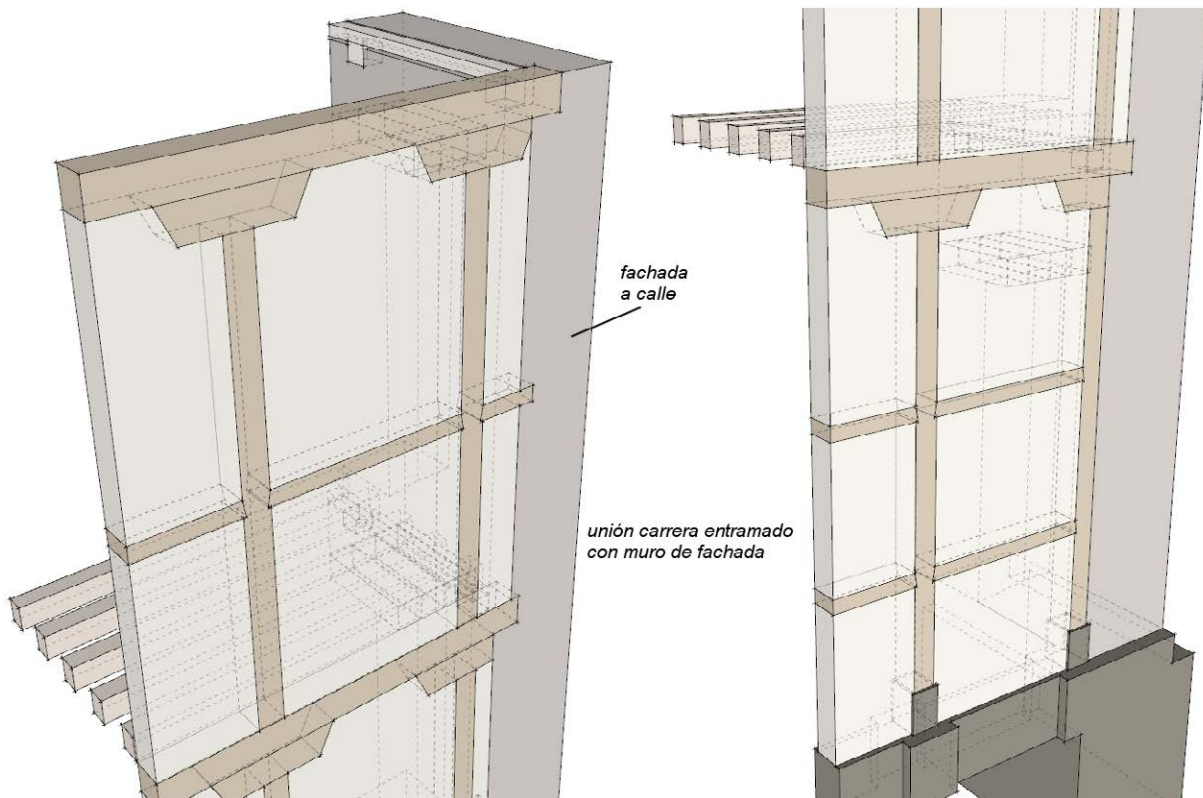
Encuentro de fachada con muro medianero de telar
